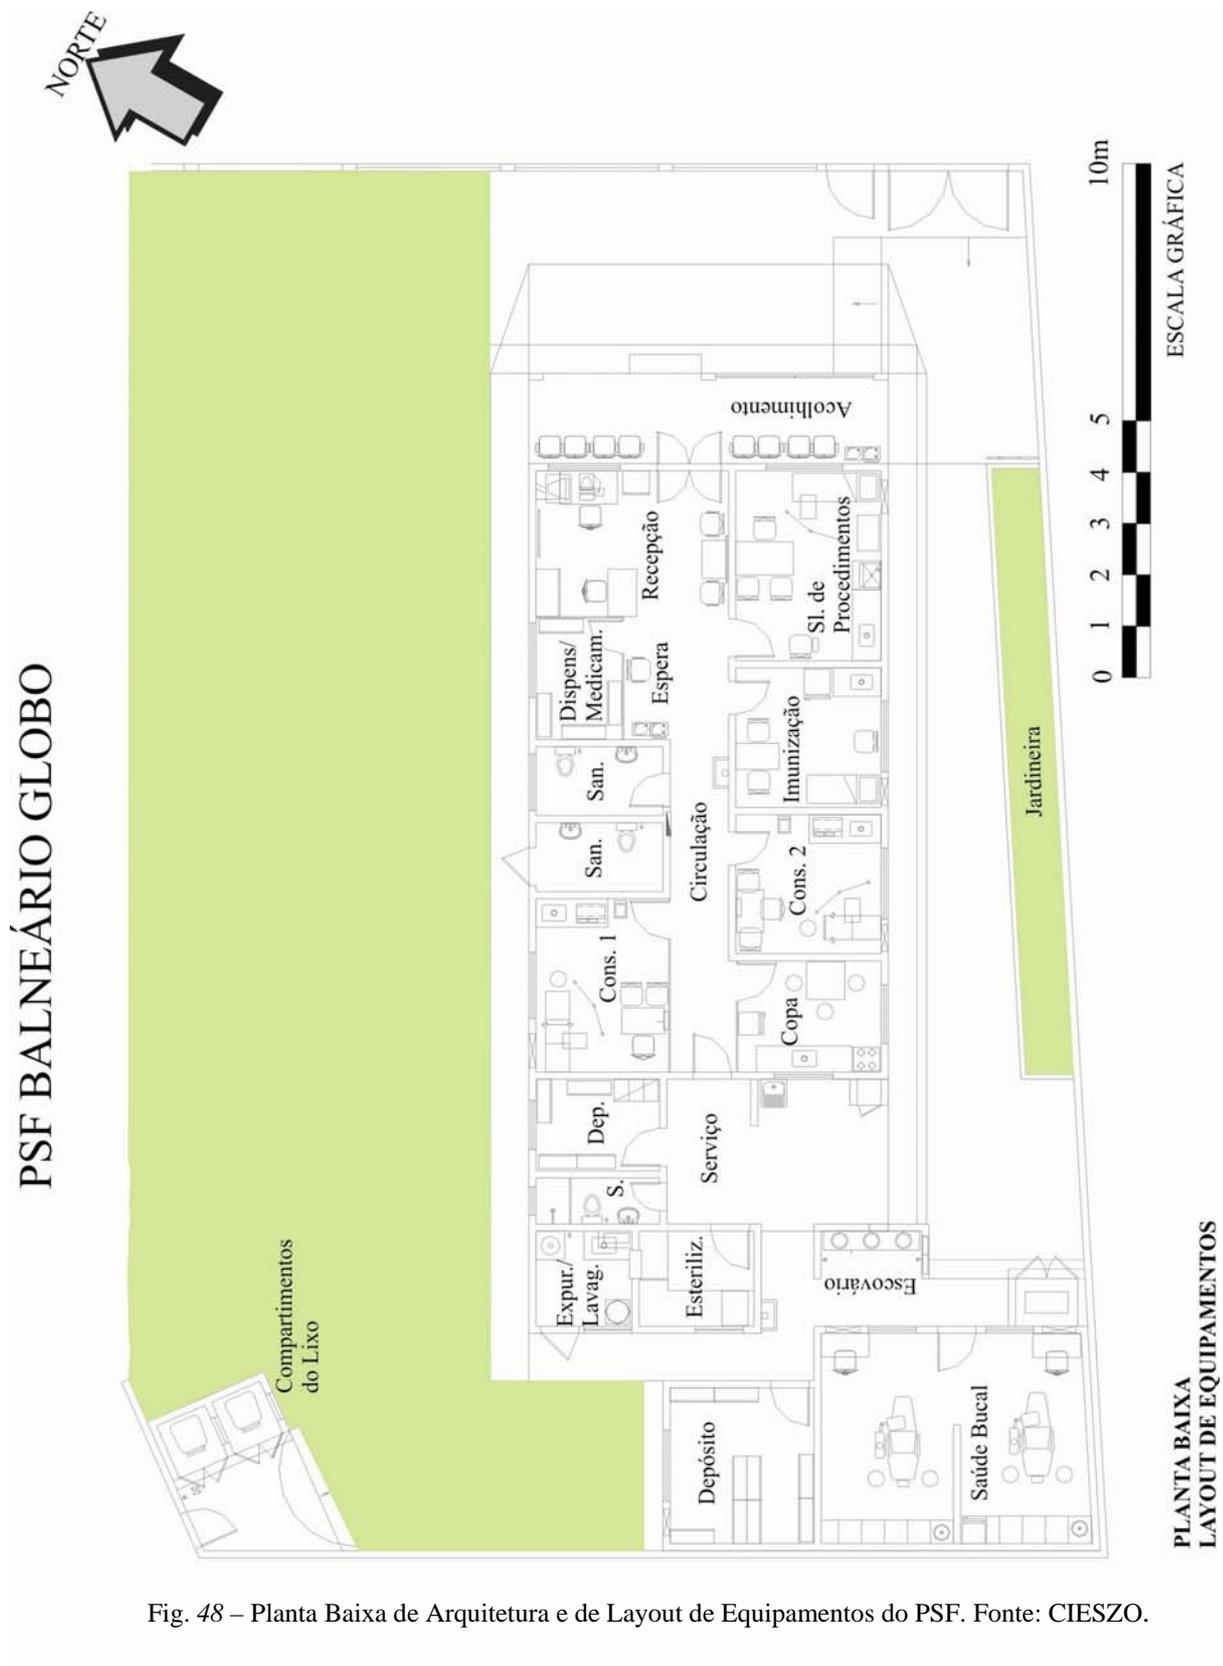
Planta Baixa de Arquitetura e de Layout de Equipamentos do PSF. Fonte: CIESZO.
